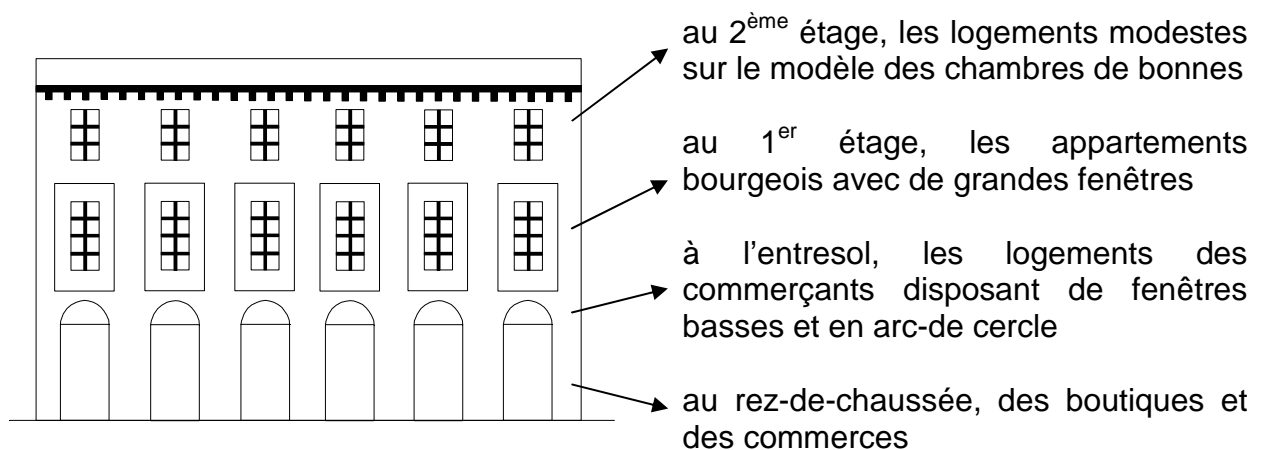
Le projet d'harmonisation des façades sur la rive droite
